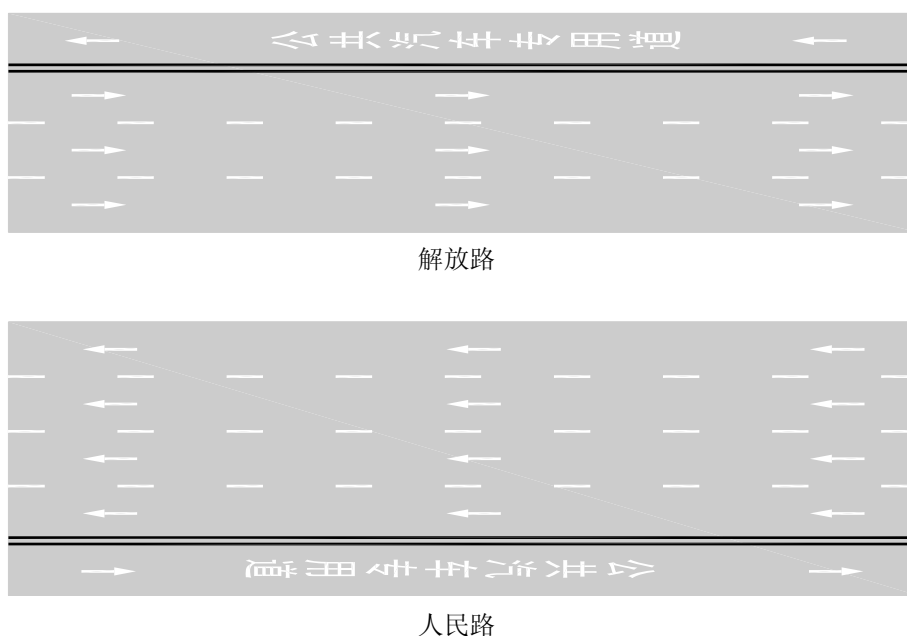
道路单向交通设计方案解放路和人民路平面布置图
